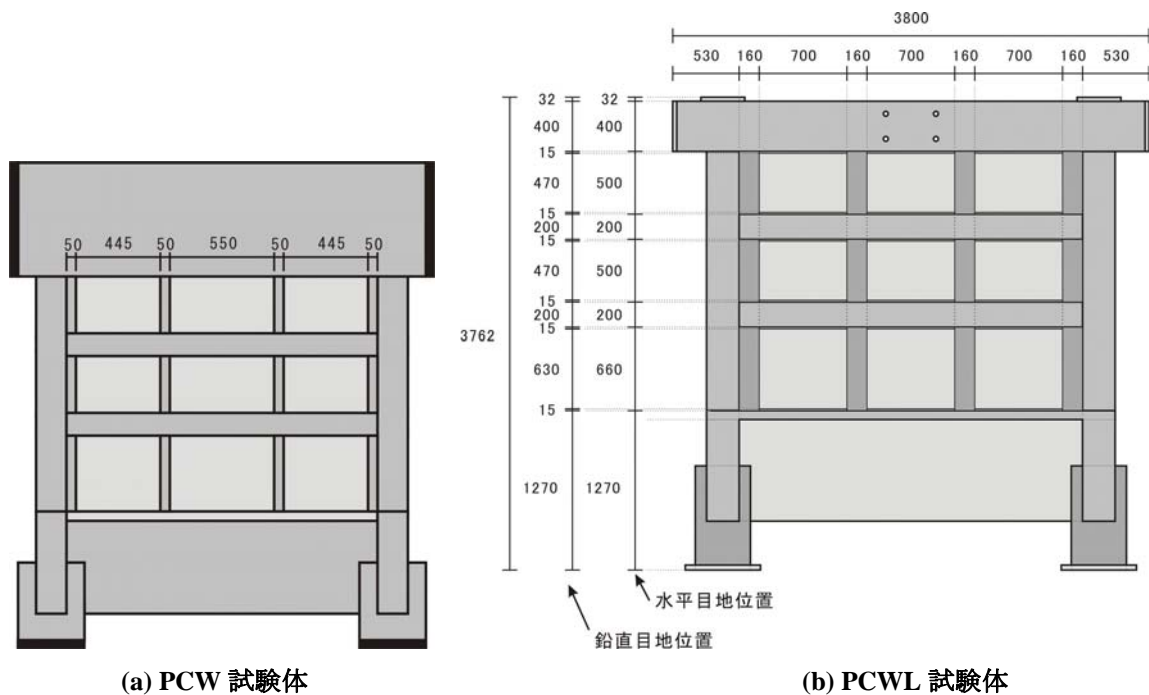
プレキャスト試験体目地位置 (unit: mm)
